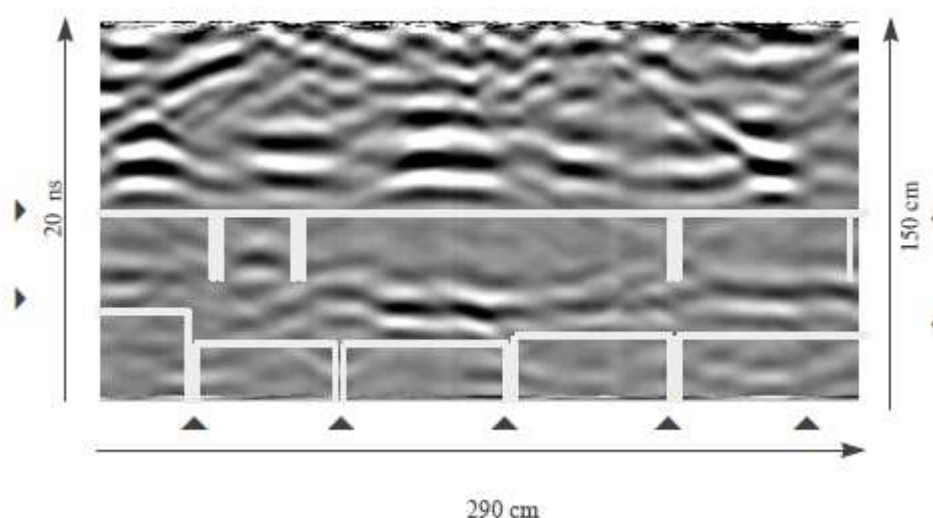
Sezione di una muratura rilevata tramite una prova radar
